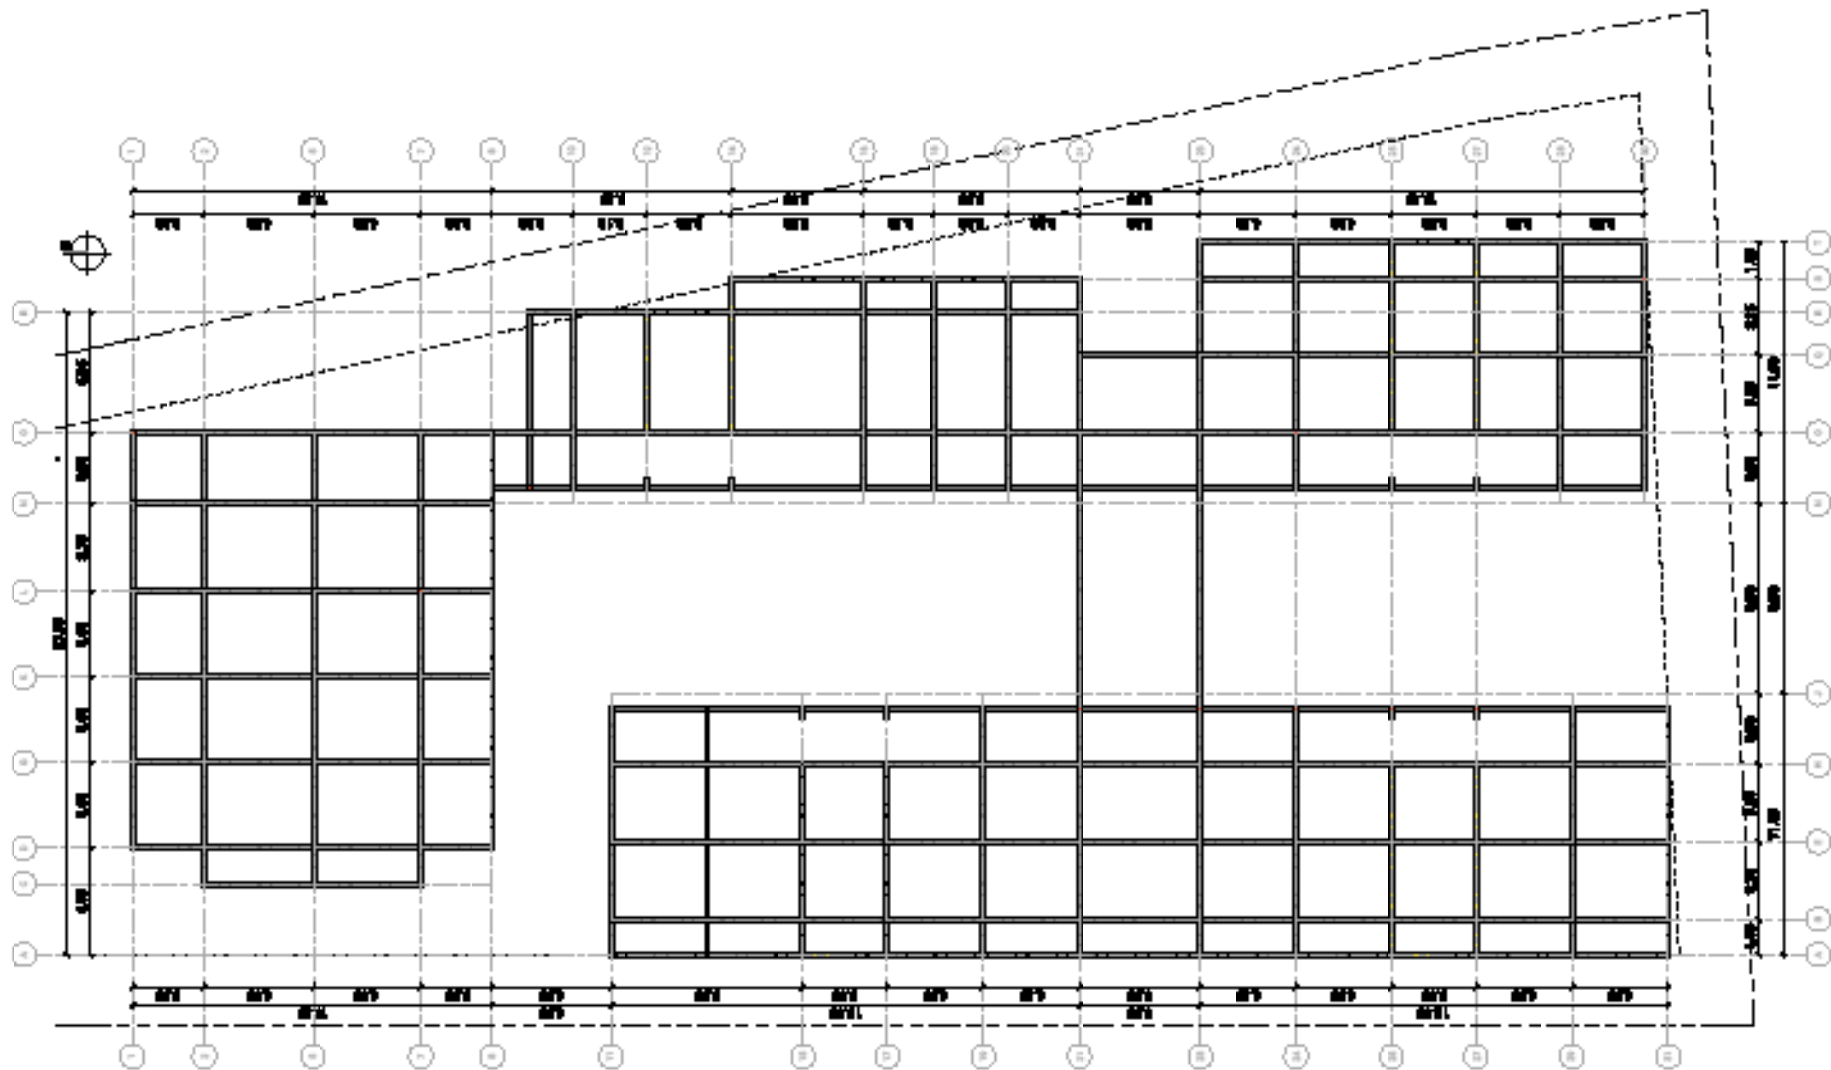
Planta de distribución de vigas y columnas de entrepiso
